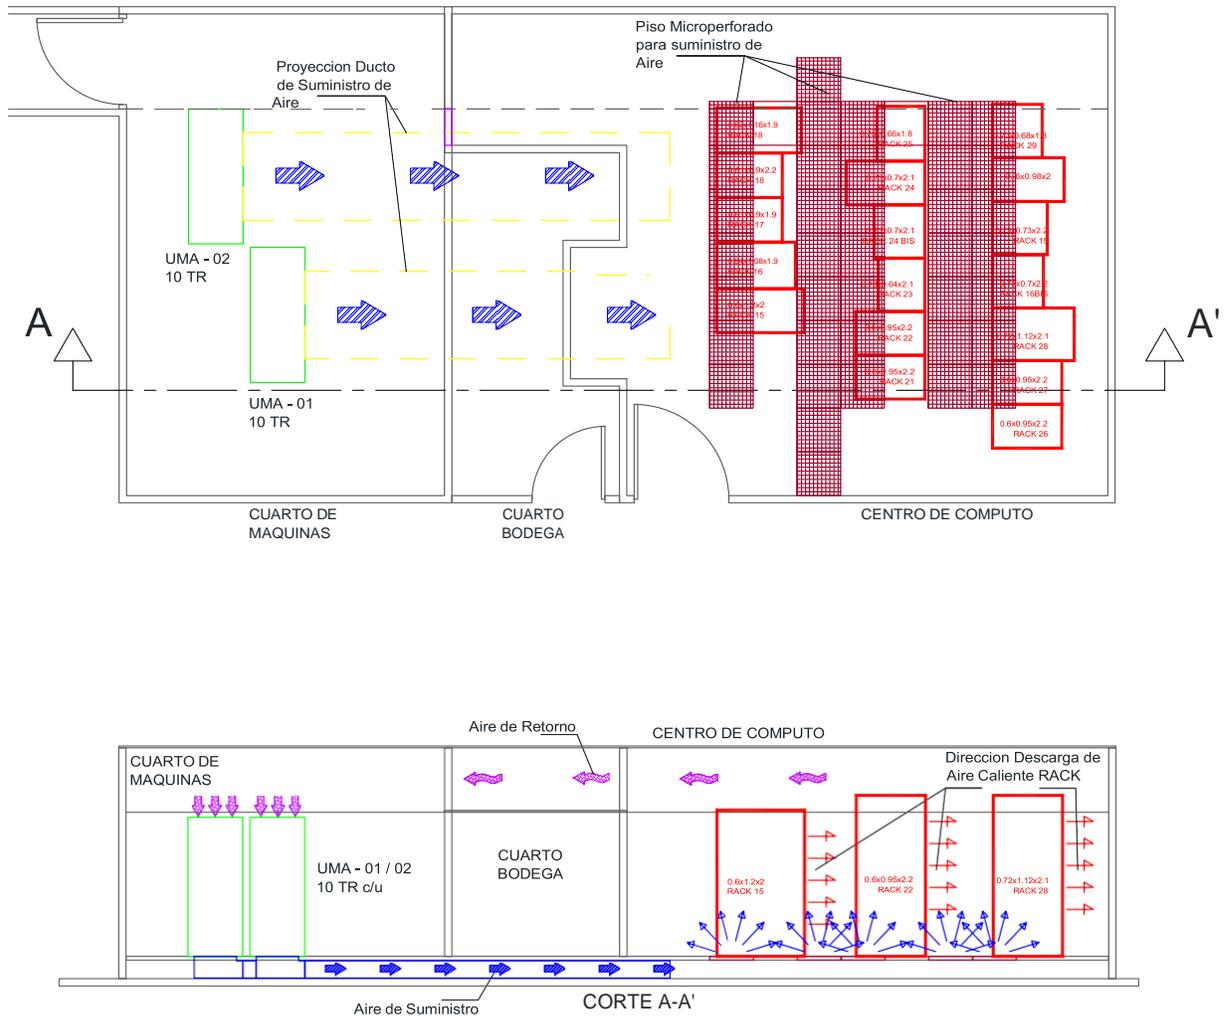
Plano Esquemático ubicación y distribución actual de equipos de aire acondicionado y Rack para el Centro de Computo Cámara de Comercio.
